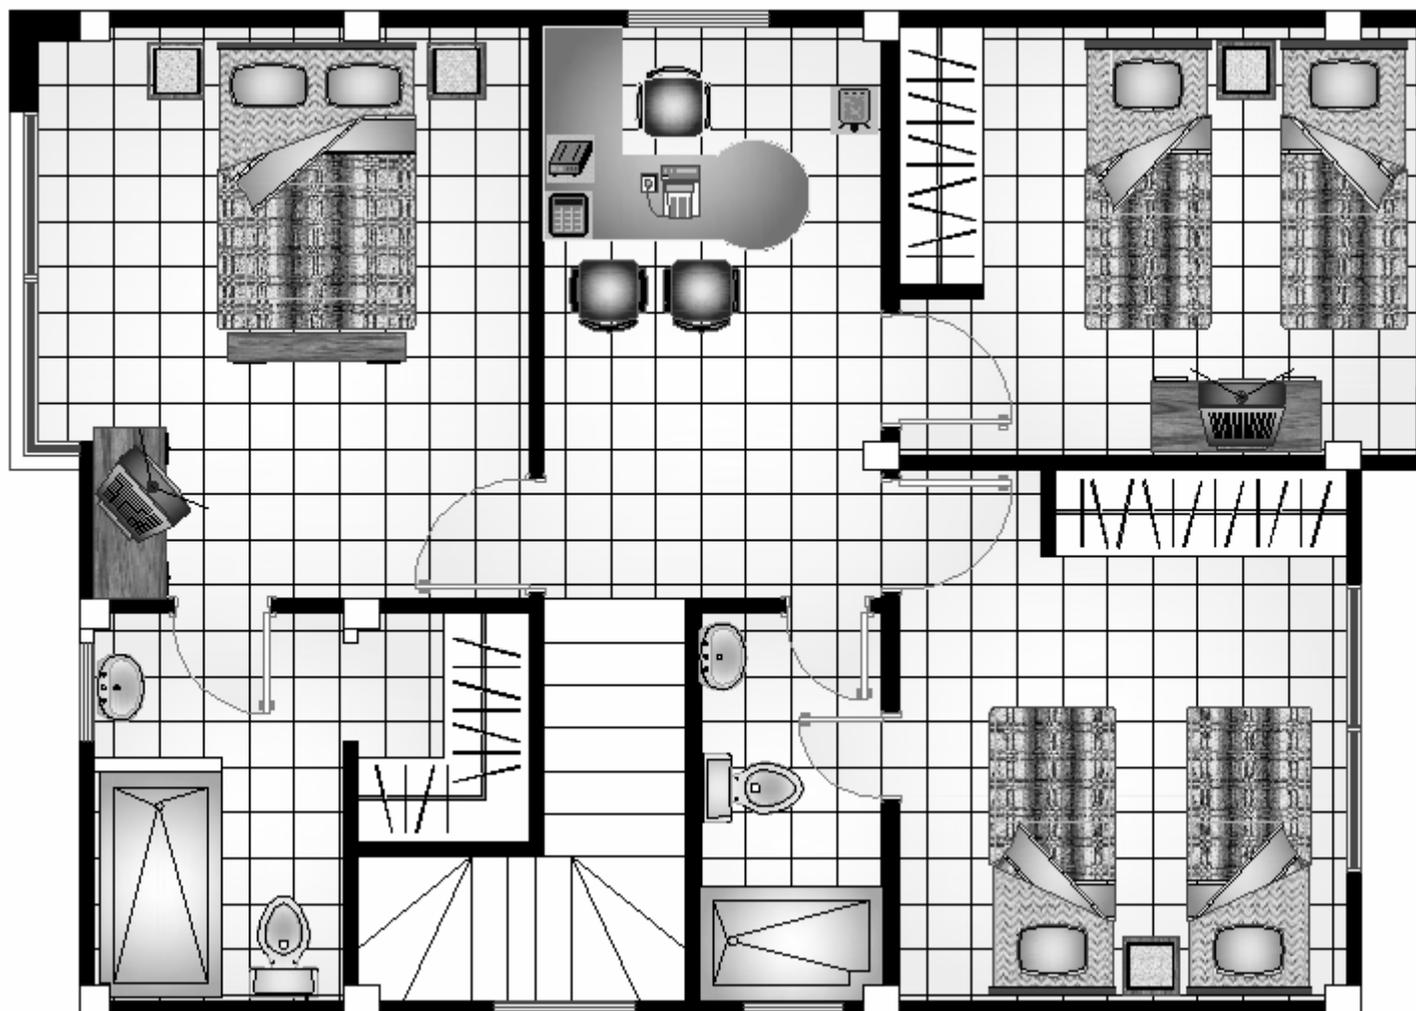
Sistema de Acceso Remoto, Planta Alta, Plano Arquitectónico.
